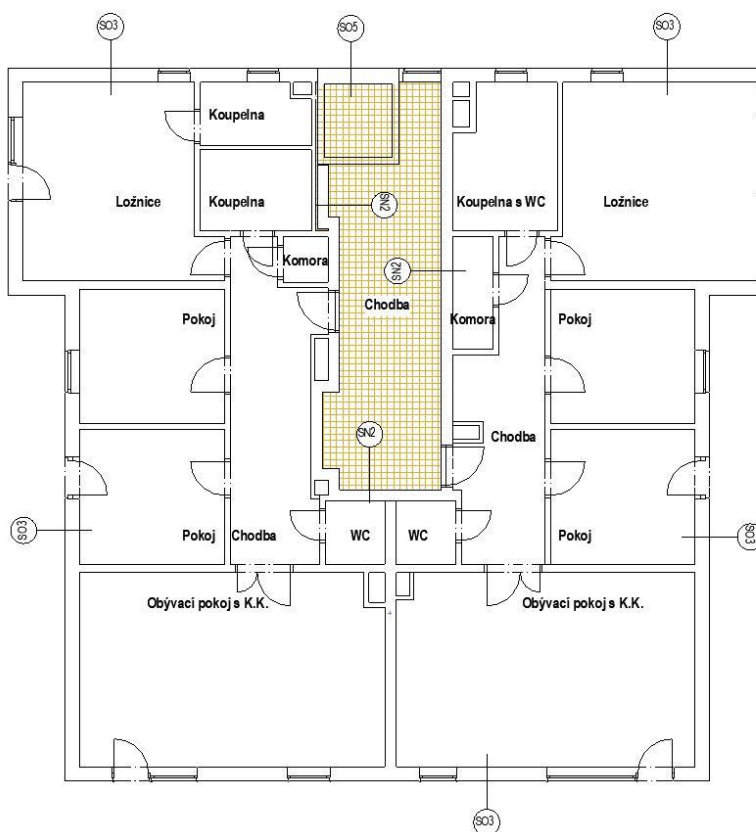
Půdorys se znázorněním zónování 1.NP
